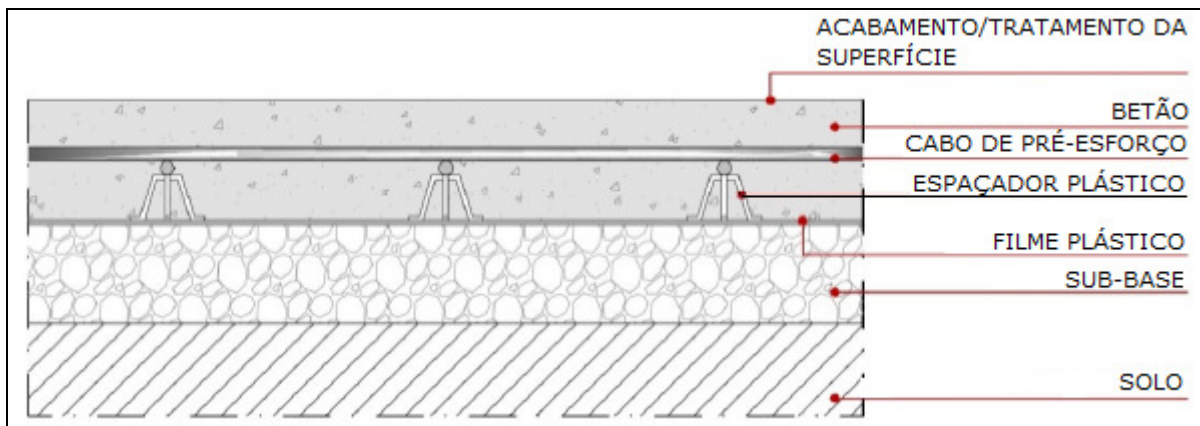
Corte: Pavimento industrial de betão pré-esforçado (Cristelli, 2010).
